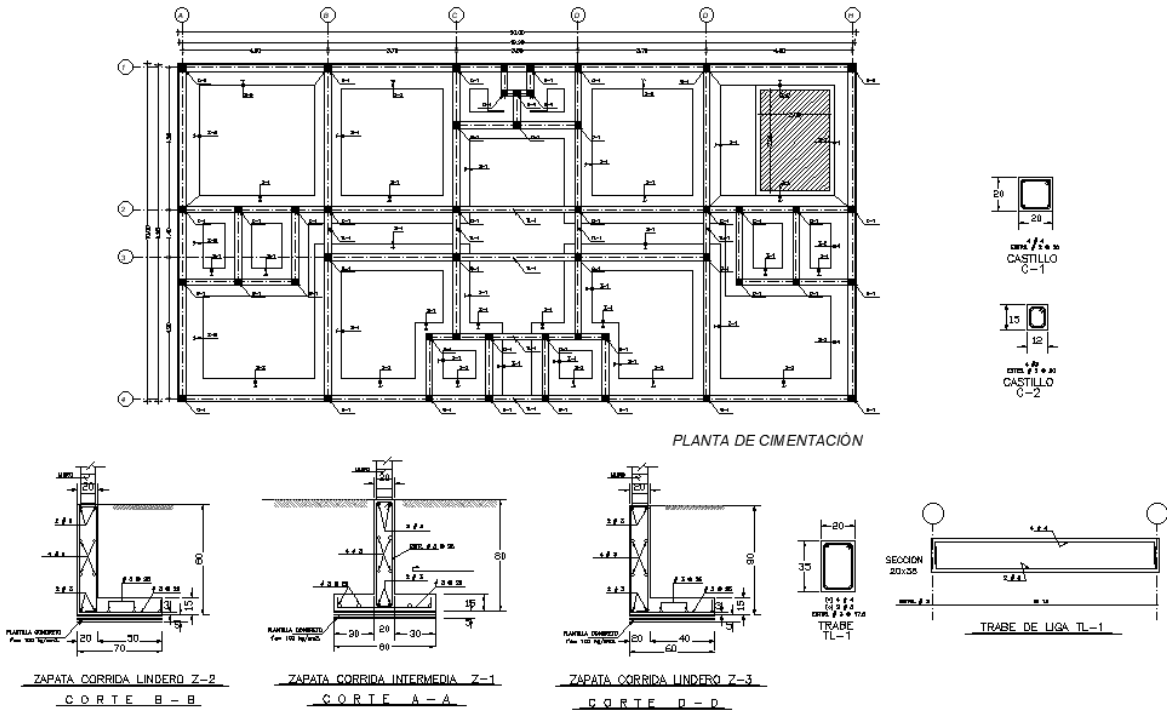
Planta de cimentación del proyecto estructural. Autoría propia.
